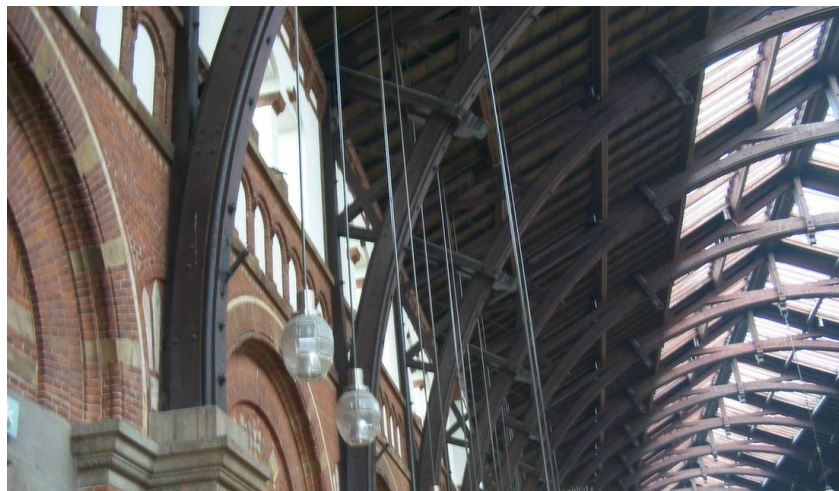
Dachkonstruktion Bahnhof Kopenhagen: Stahl-Holz-Mauerwerk
